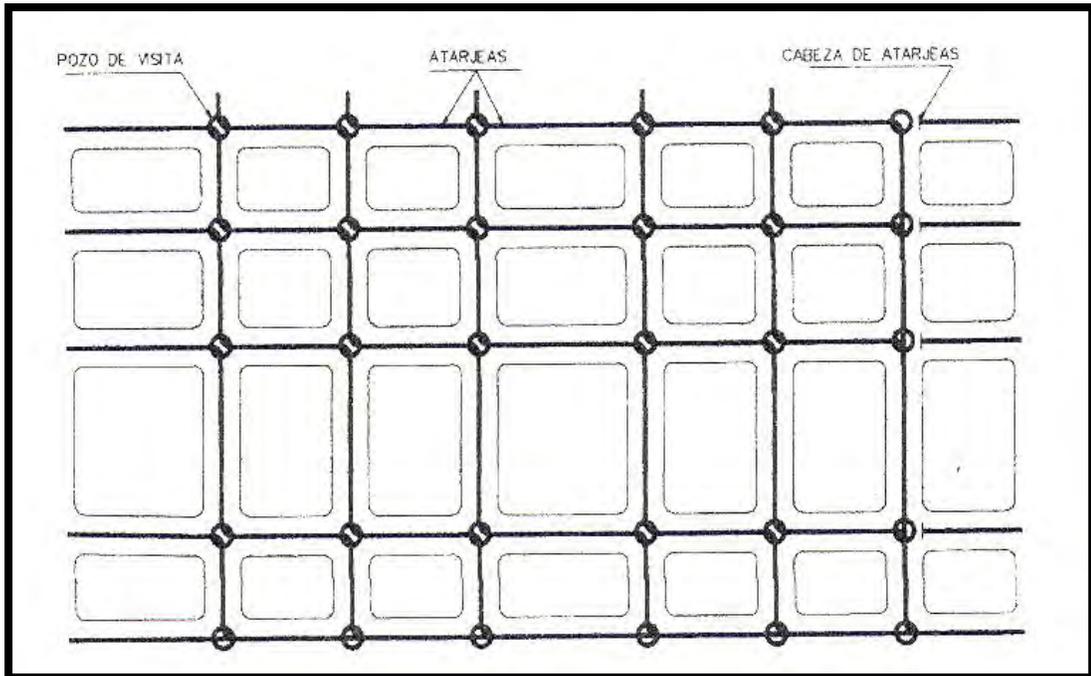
Trazo en bayoneta para el sistema de alcantarillado, (Ref.1)
